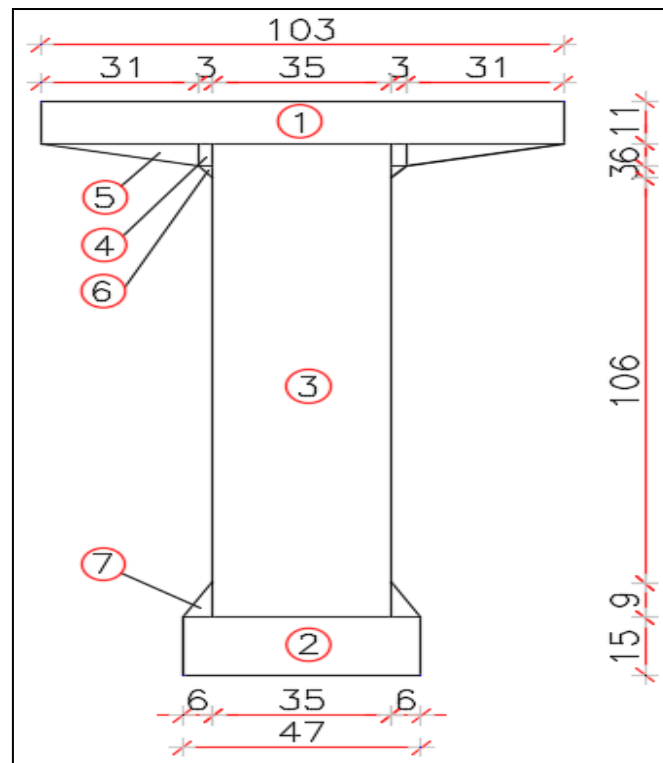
Section intermédiaire de la poutre intermédiaire sans hourdis.
